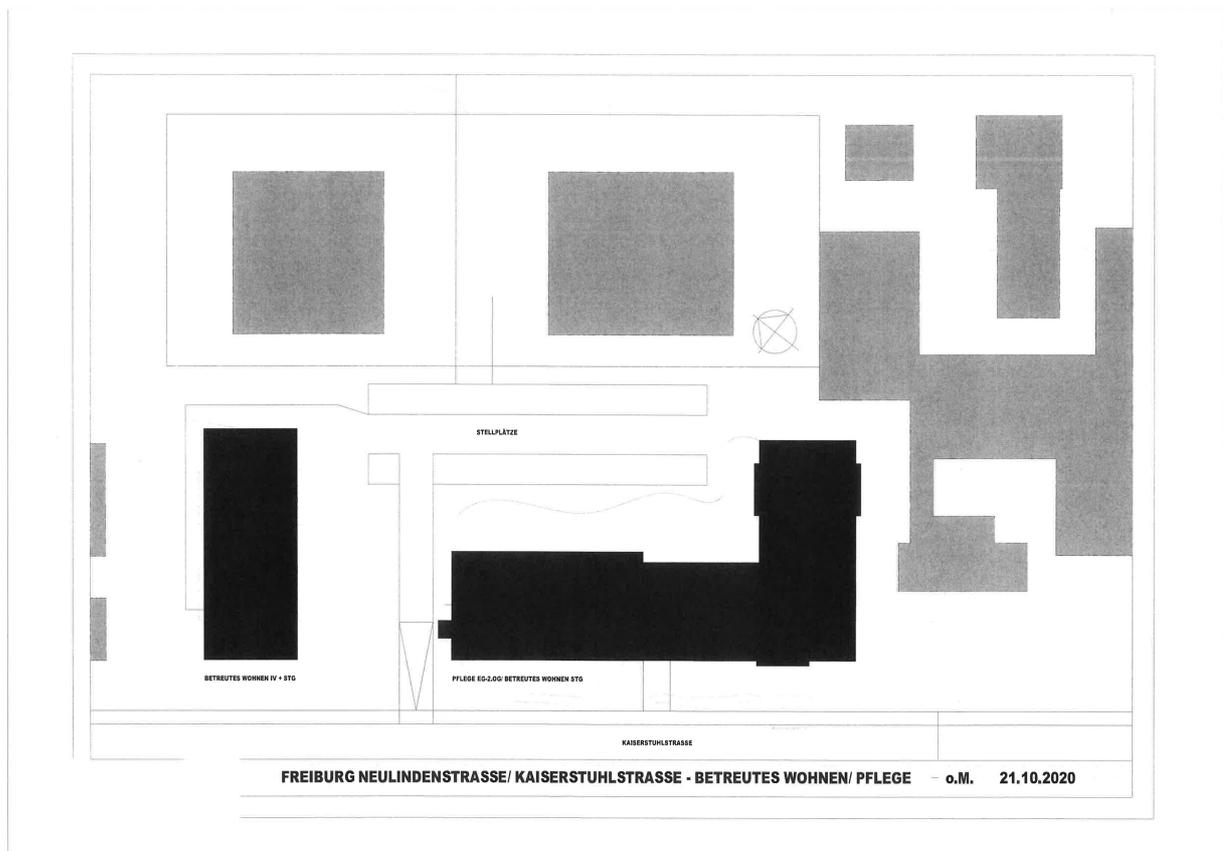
/ Anlagen 16/17: bisherige Konzeption im erweiterten Plangebiet Kaiserstuhlstraße
